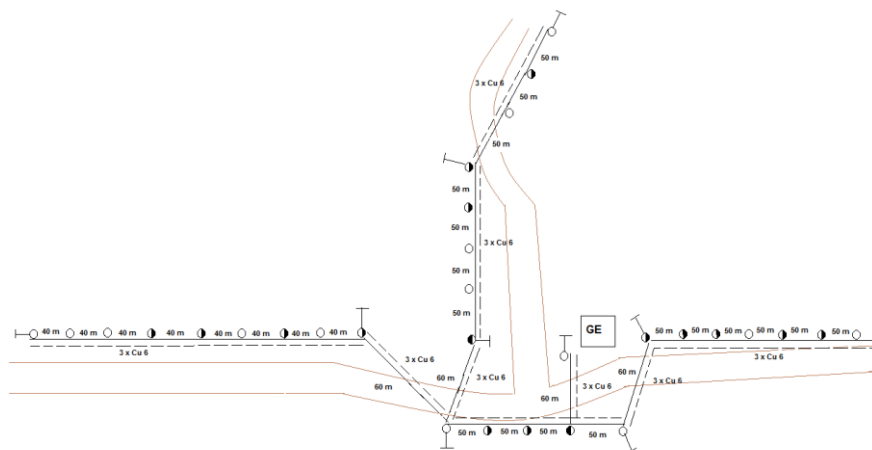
Plano con la red de distribución existente (fuente: UNE)
